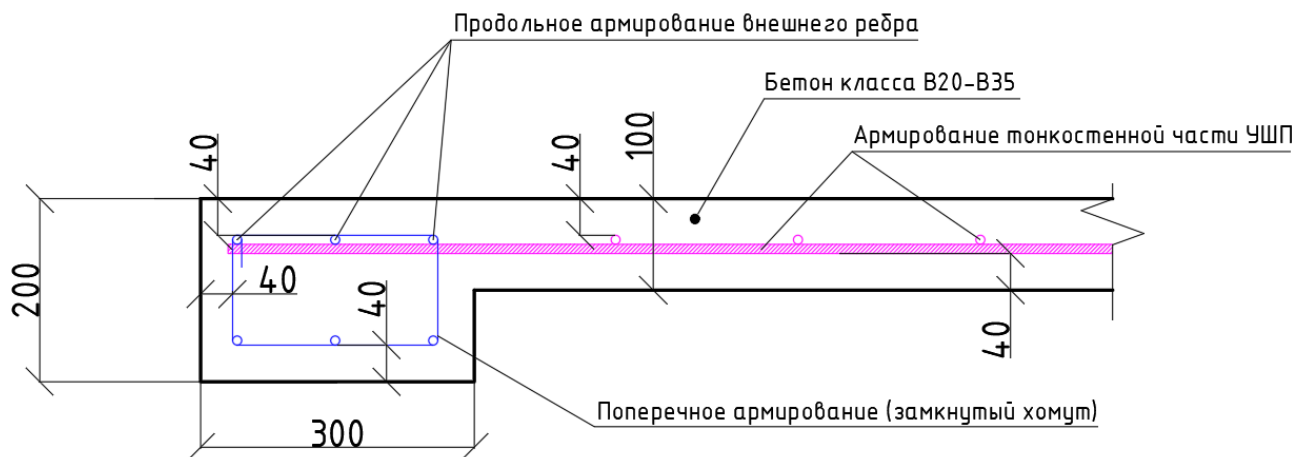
Принципиальная схема армирования наружного несущего ребра высотой 200 мм (пример для деревянного каркаса, для бескаркасной конструктивной схемы с несущими каменными стенами по аналогии с рисунком Б.4)
